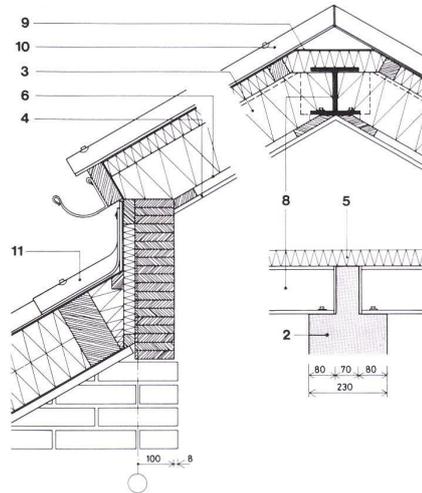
Senkrechter Schnitt durch die Dachkonstruktion, Typ 1, 1:10. (2) 230 mm Betonelement-Wand. (3) 150 x 63 mm Balkensparren alle 600 mm. 150 + 50 mm Mineralwolle. (4) 13 mm Gipsplatte. (5) Feuerschutzplatten. (6) Dampfsperre mit verklebten Verbindungen. (8) Stahlprofilbalken, HE 140 B. (9) Zinkeindeckung. (10) Eternit-Wellenplatte. (11) Eternit-Formstück, 30°.
